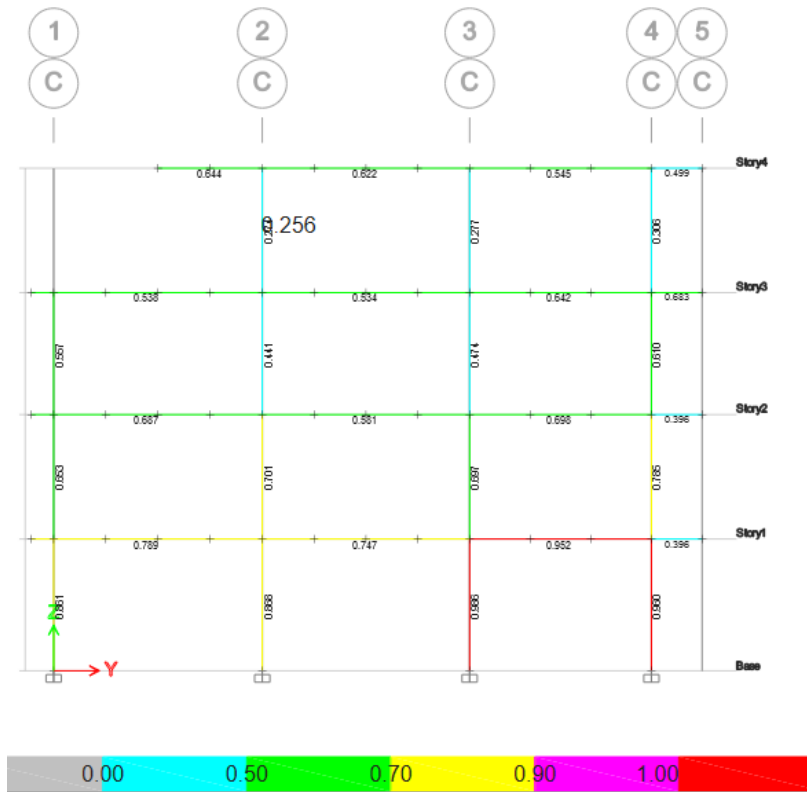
Vista en elevación eje C de secciones principales, con diseño AISC 360-16- demanda/capacidad
